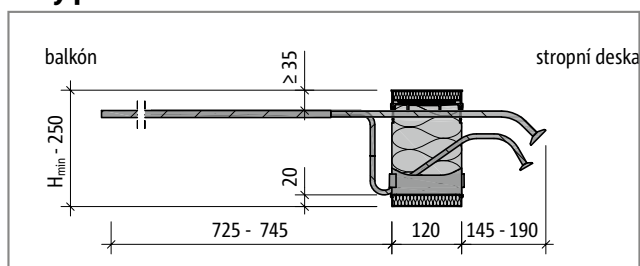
Schöck Isokorb® XT typ KL-WO: Řez prvkem
